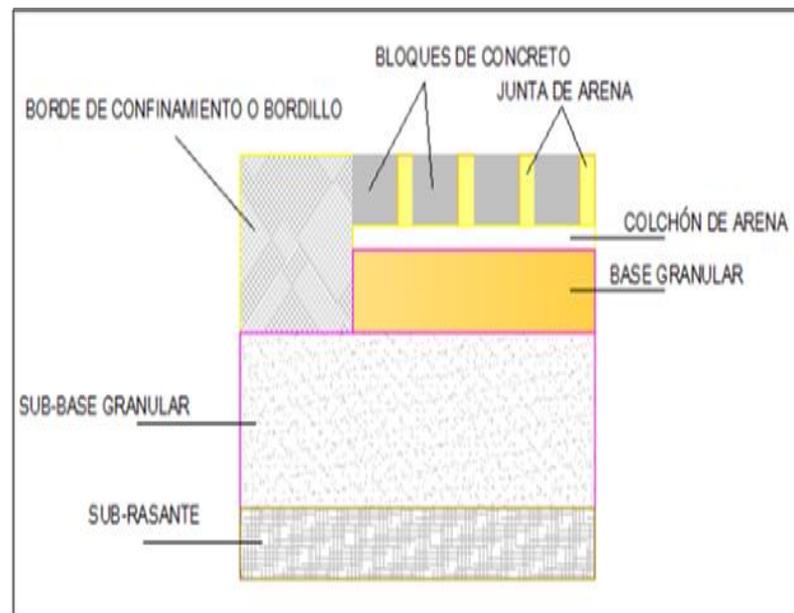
Elementos que componen un pavimento articulado. Fuente: Universidad Católica de Chile, Diseño Pavimentos Articulados, 2011.
